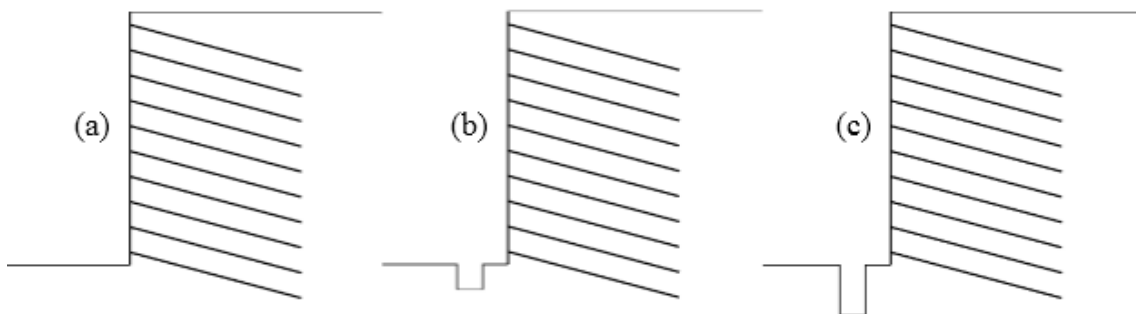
Geometria típica de talude com face vertical onde há possibilidade de escavação próxima à base. (a) sem escavação, (b) 1 m de escavação e (c) 2 m de escavação
